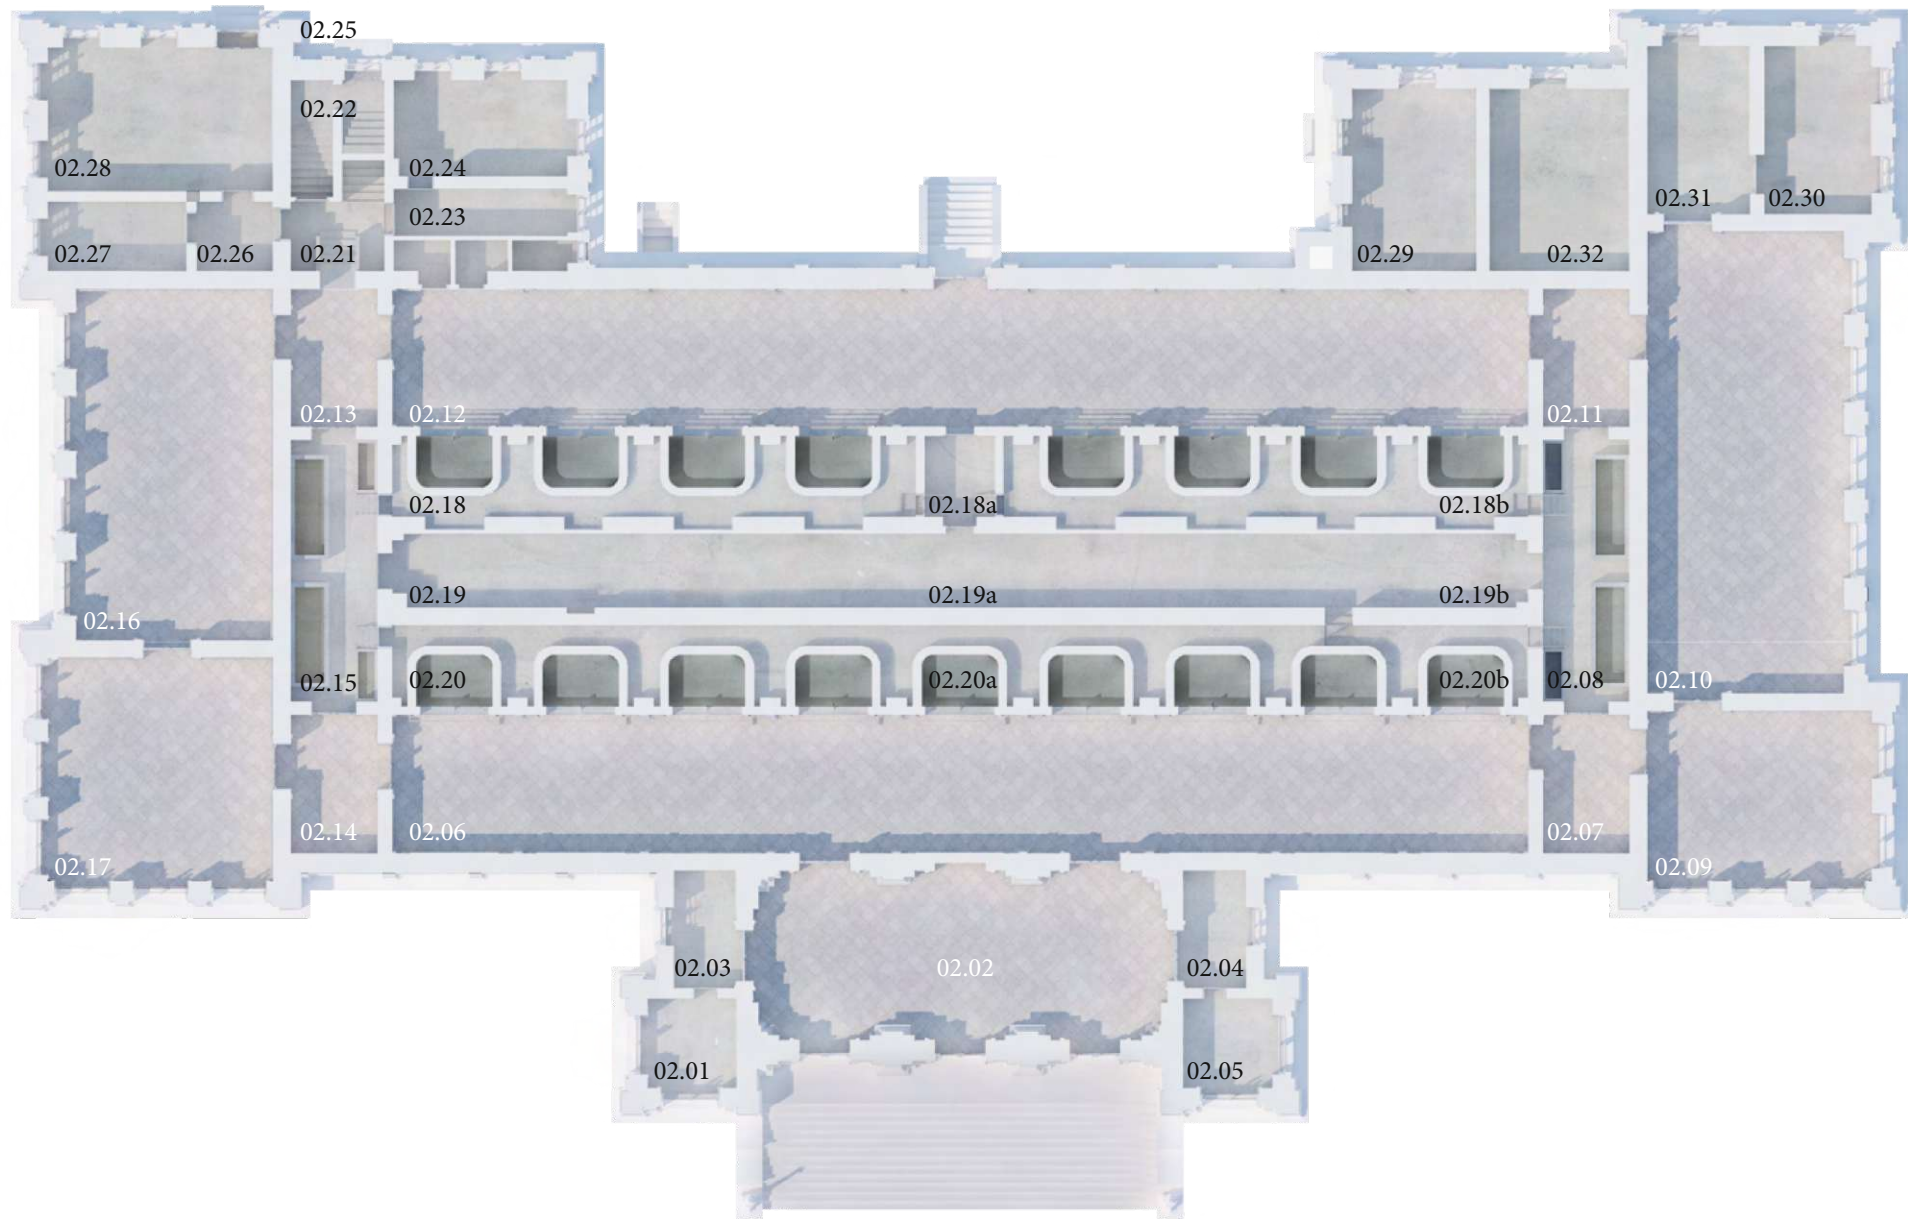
Rekonstruktionsmodell: Horizontalschnitt Erdgeschoss | Bestand vor BVA
